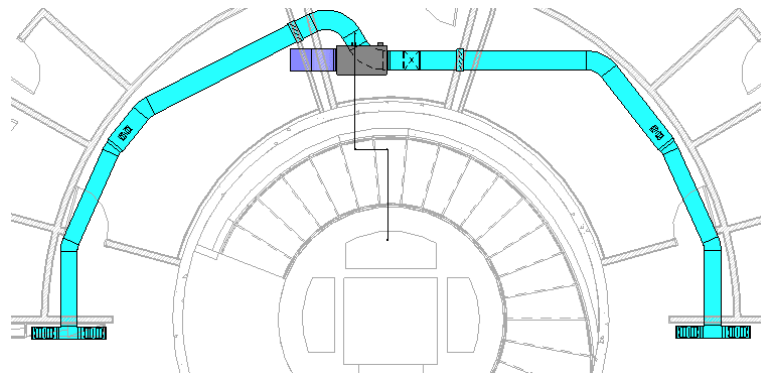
Sistema de aire primario (Vistas de planta)
